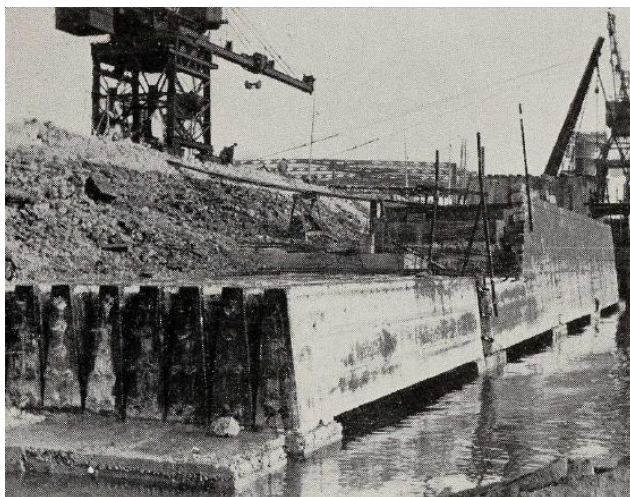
Quai Joannès-Couvert– Reconstruction, linteaux en poutres préfabriquées en béton précontraint 15t ([3])
